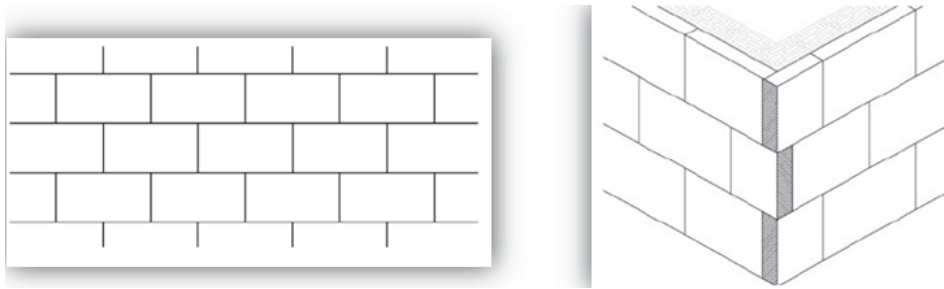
Montaje placas. Fuente: www.weber.es
